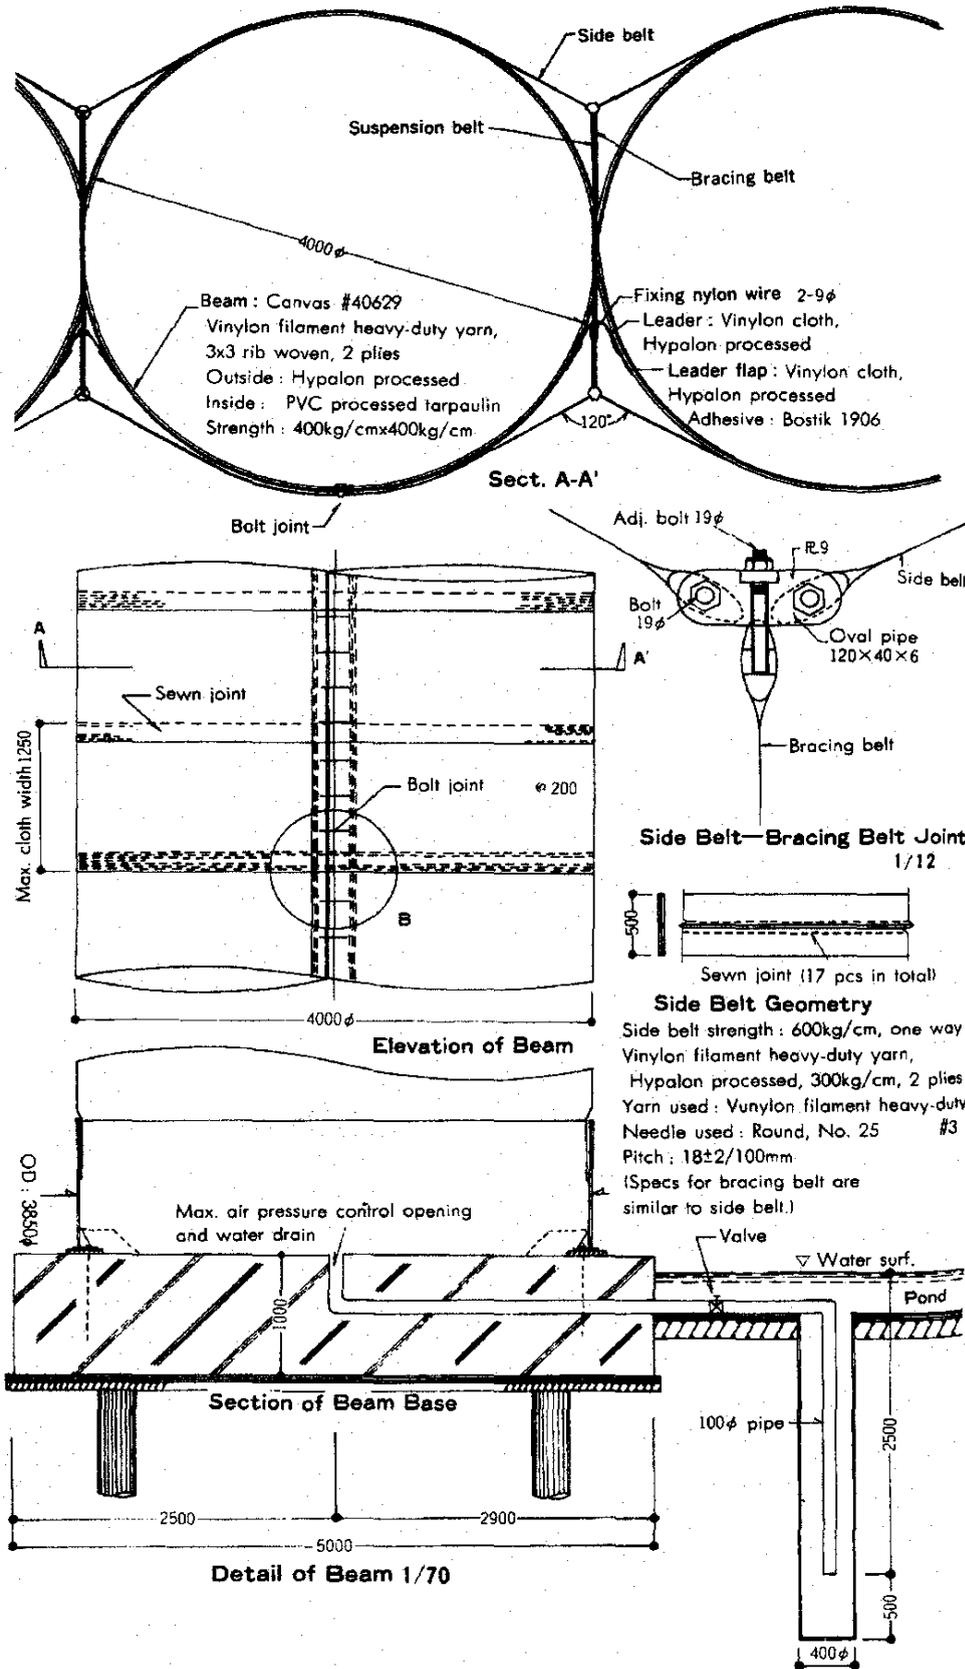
Pavilhão da Fuji (detalhes constructivos). [32]
